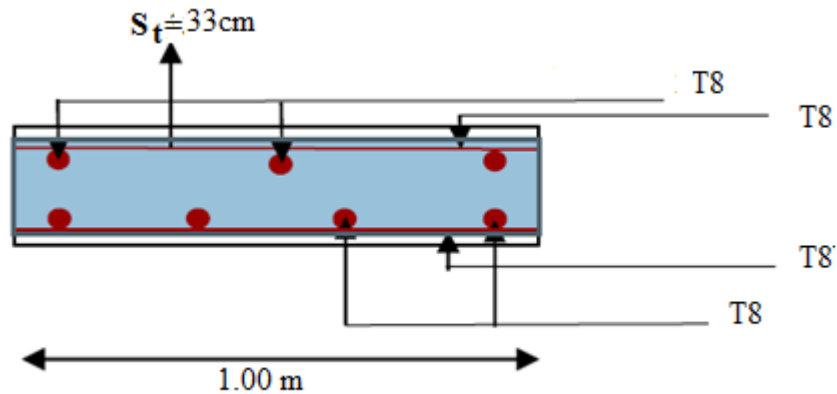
Schéma du ferrailage de la dalle au-dessus de l'ascenseur.
